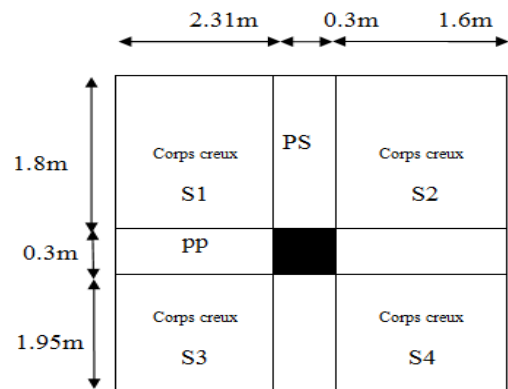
La surface afférente du poteau le PC3 (Terrasse inaccessible + accessible)
